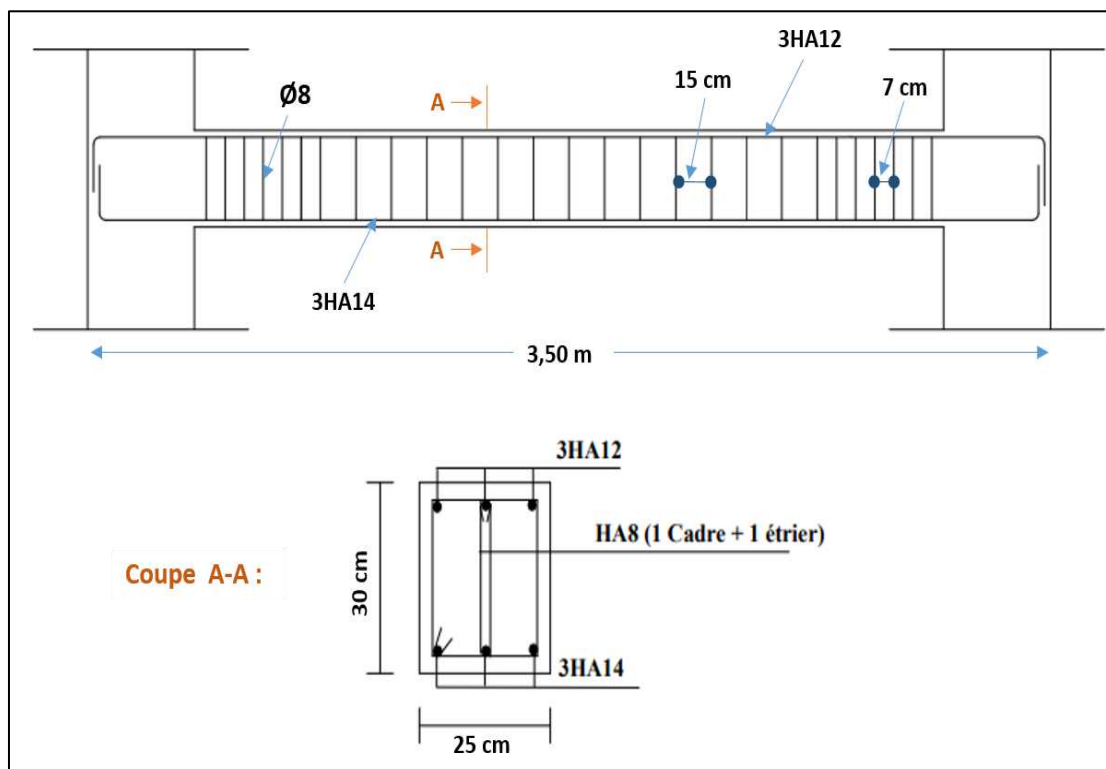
Schémas de ferrailage de la poutre palière.
